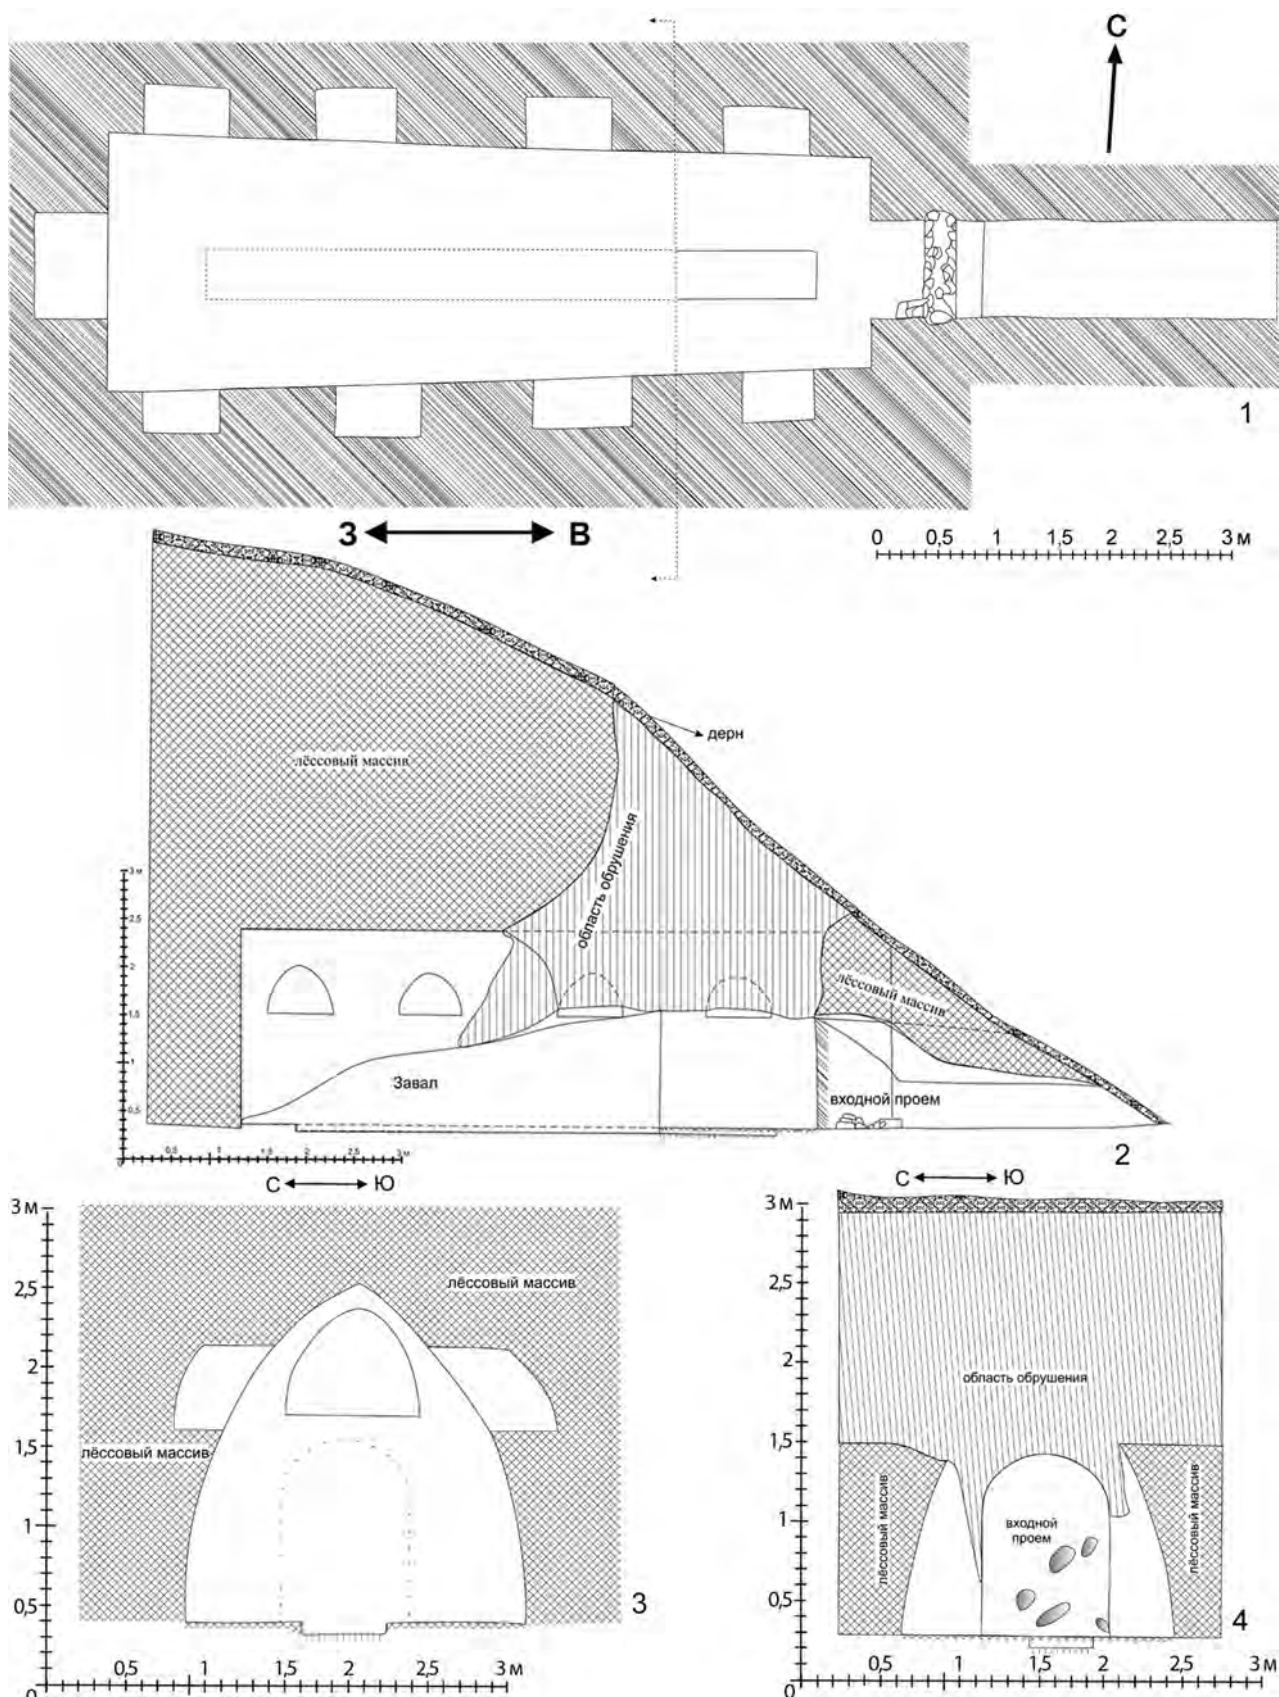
1 — план науса; 2 — разрез северной стены и входного проема (по линии 3-В);
